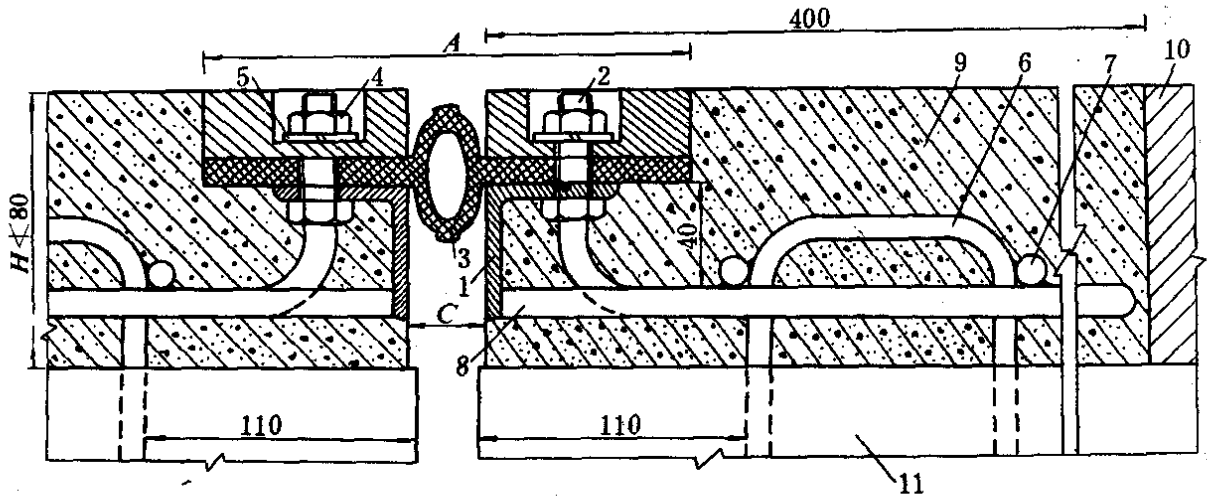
管形橡胶条型伸缩装置构造示意图 (尺寸单位: mm)
